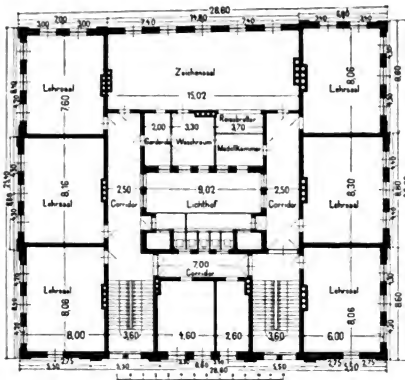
Grundriß der Seemaschinistenschule zu Bremerhaven.
